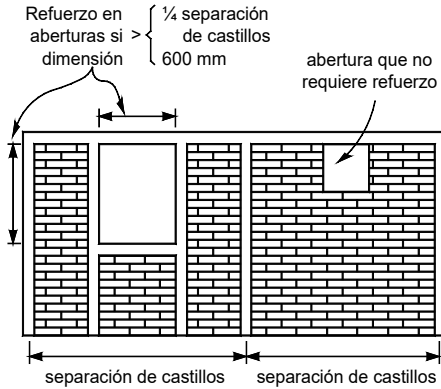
REFUERZO EN EL PERÍMETRO DE ABERTURAS
